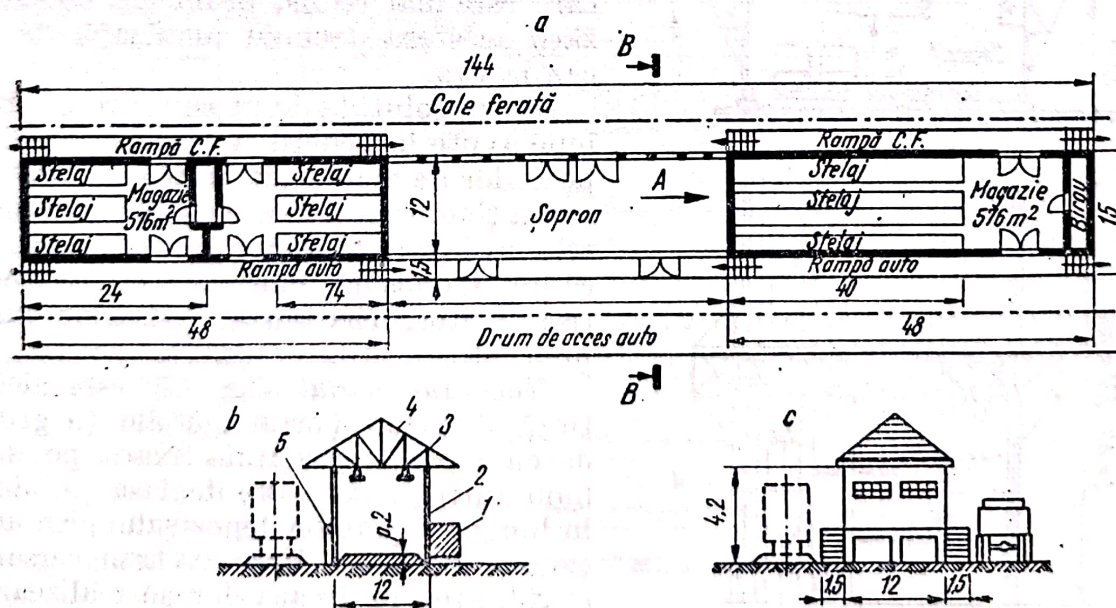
Depozit cu șopron pentru materiale de instalații :
